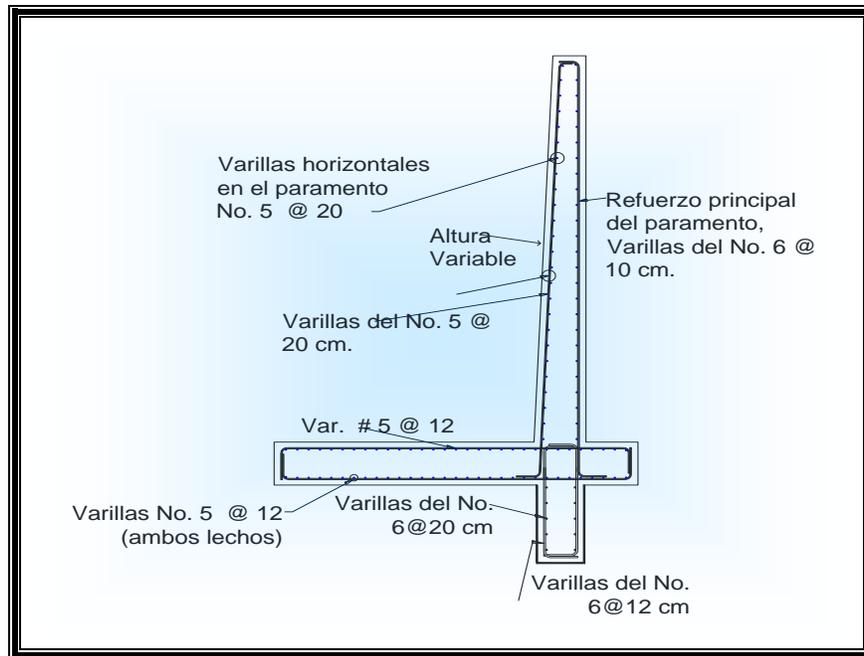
Acero de Refuerzo en Estructura de concreto
